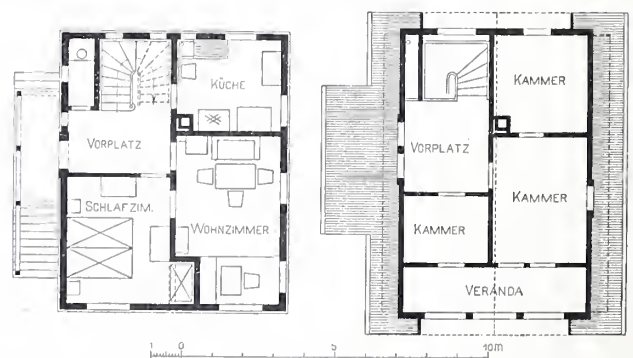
Grundrisse vom Erdgeschoss und Dachstock zu Abb. 1. Masstab 1:250.
